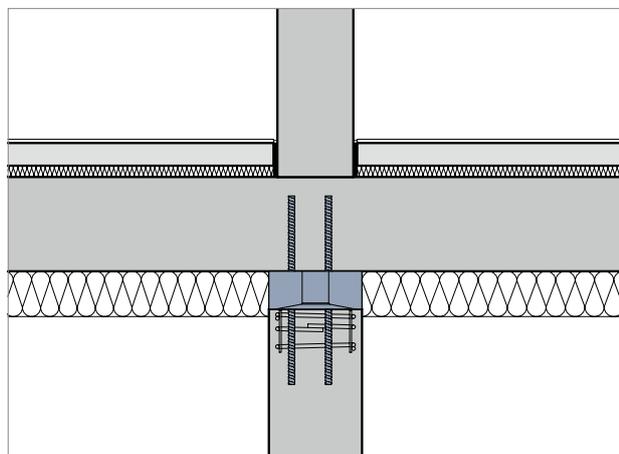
Schöck Sconnex® type P pour poteau intérieurs et isolation sous la dalle
